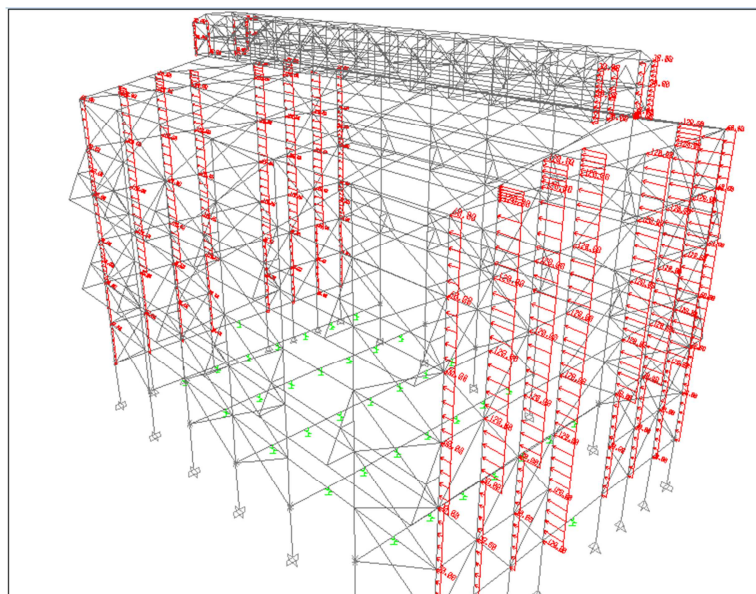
Carga de Viento en el eje Y (V_y) aplicadas a la
